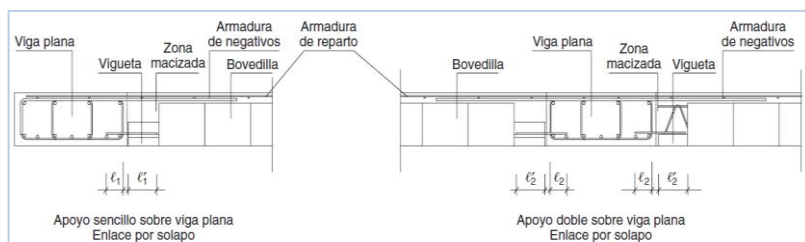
y 24. Apoyo sobre viga plana. Enlace por solapo
